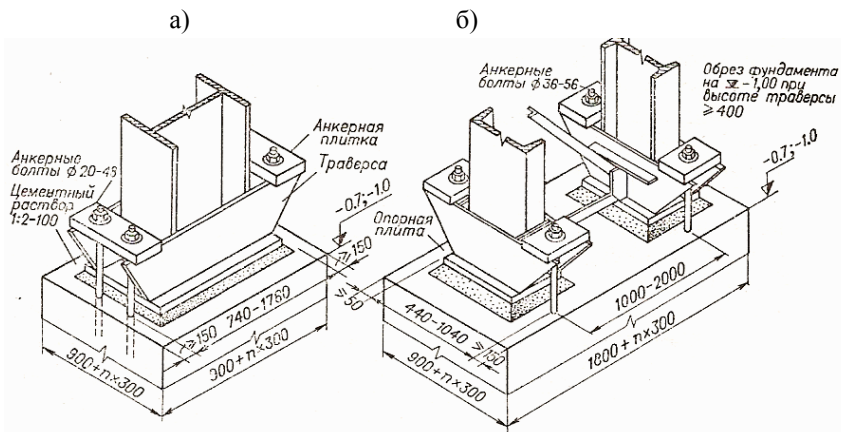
Монолитные фундаменты под стальные колонны:
